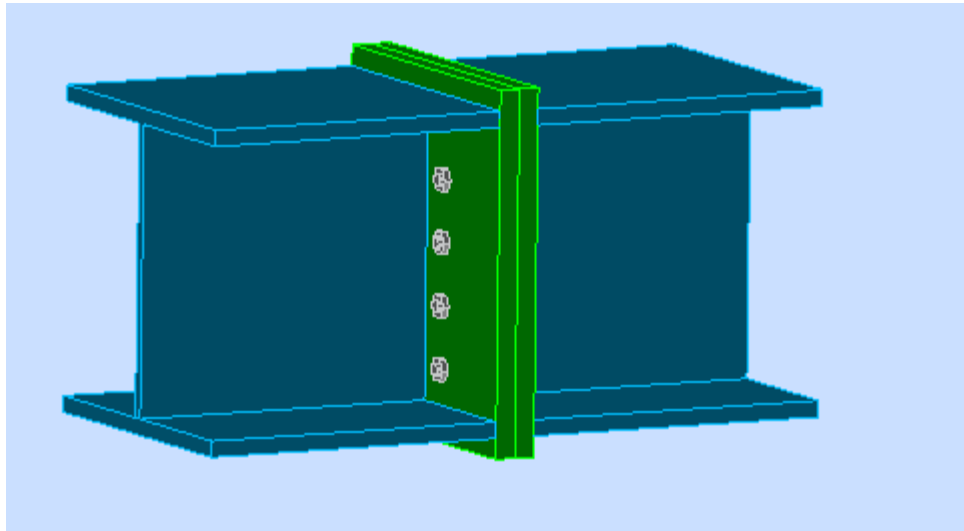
Vue de l'assemblage poteau - poteau.
